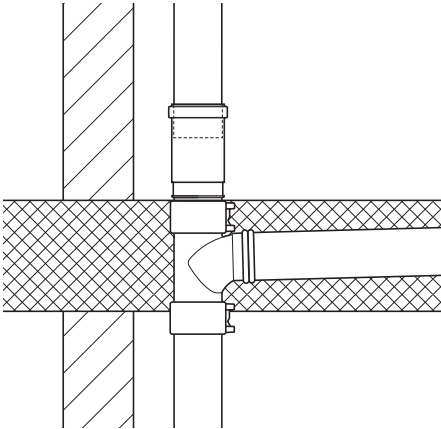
Likformigt grenrör 88,5°, betongingjutet
